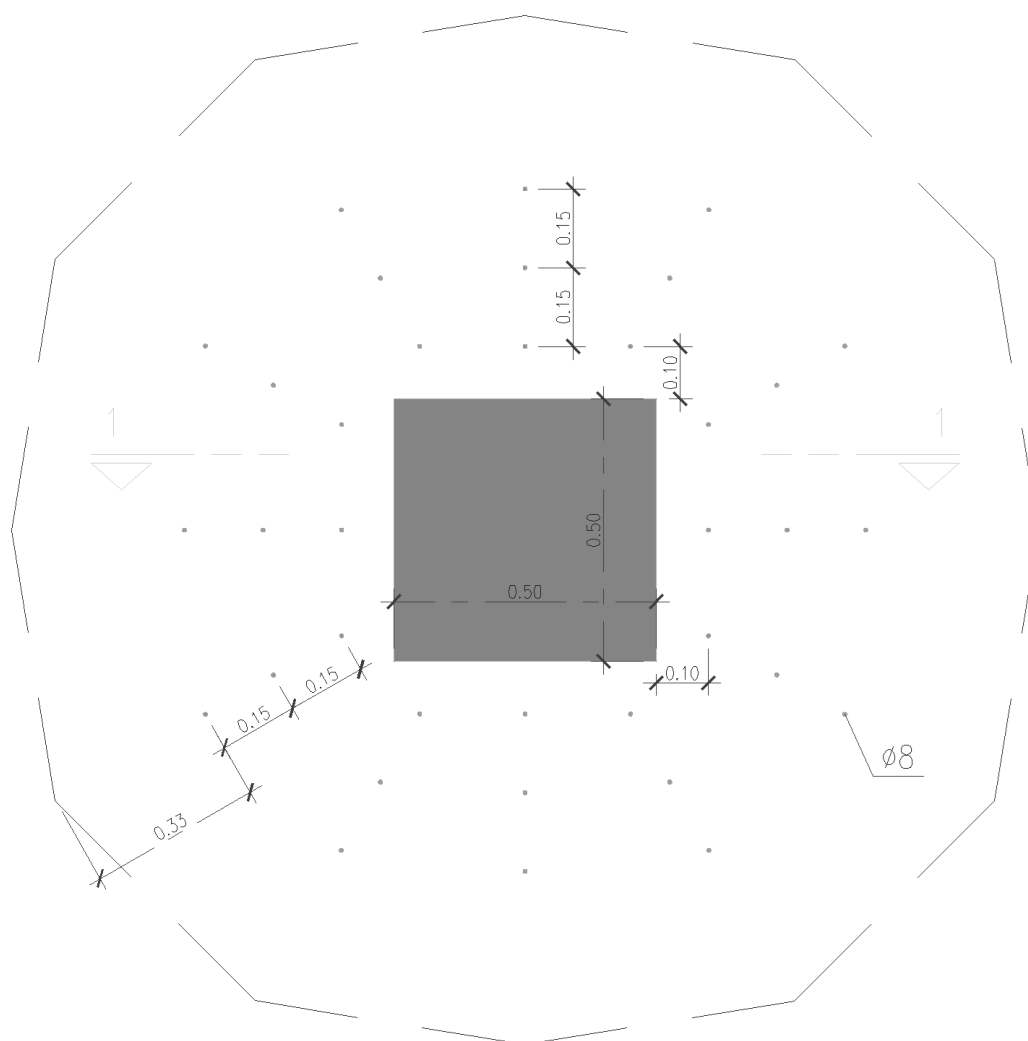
Planta da armadura de punçoamento do primeiro caso em análise (pilar interior).
